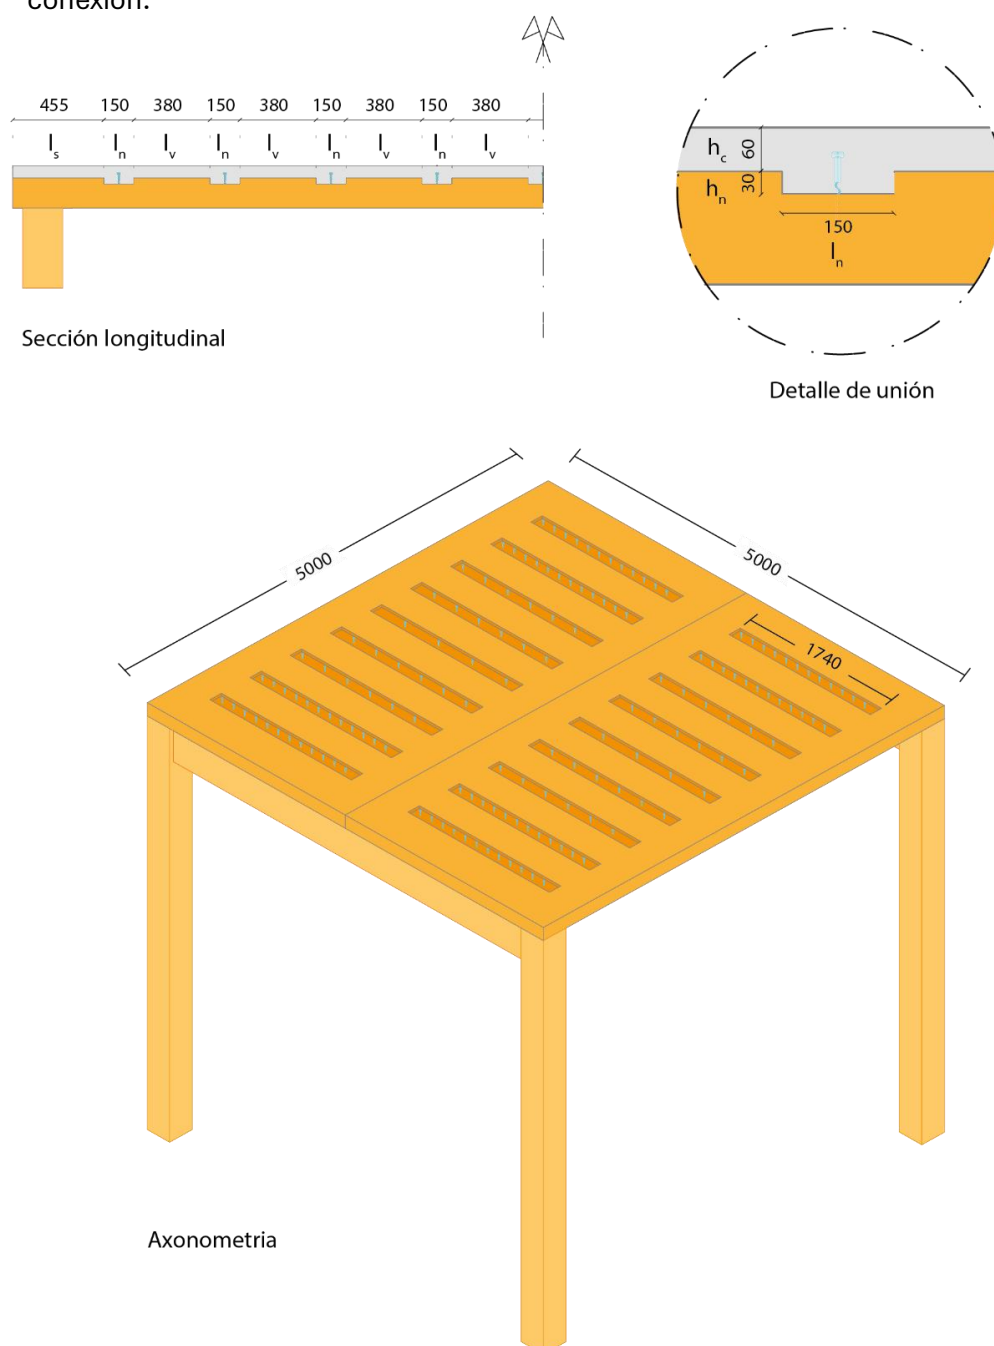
Dimensiones de las entalladuras en los paneles de CLT.
